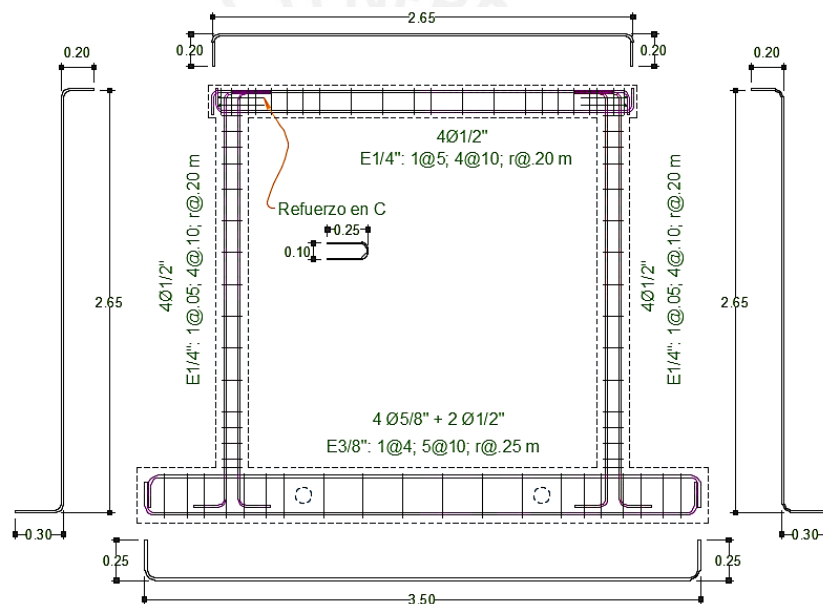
Detalle de los refuerzos de los elementos de confinamiento del muro
